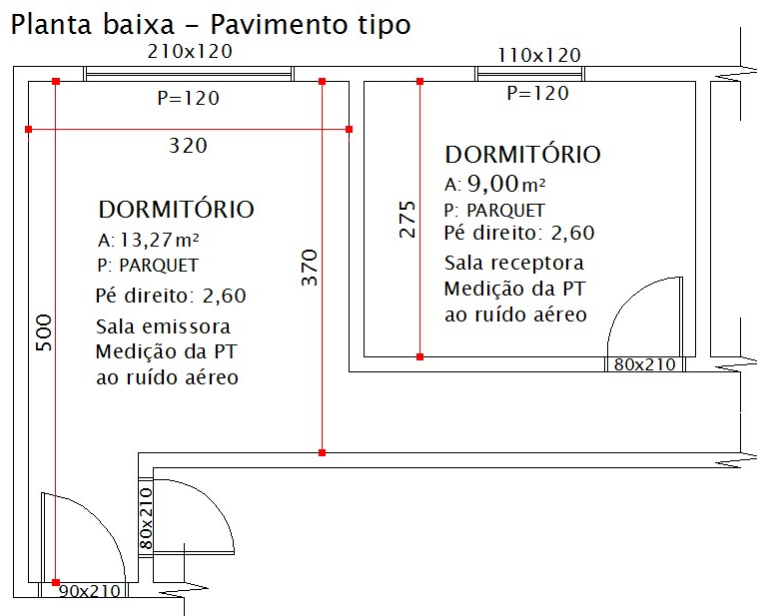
Planta baixa - pavimento tipo - 02-PIS-TV
